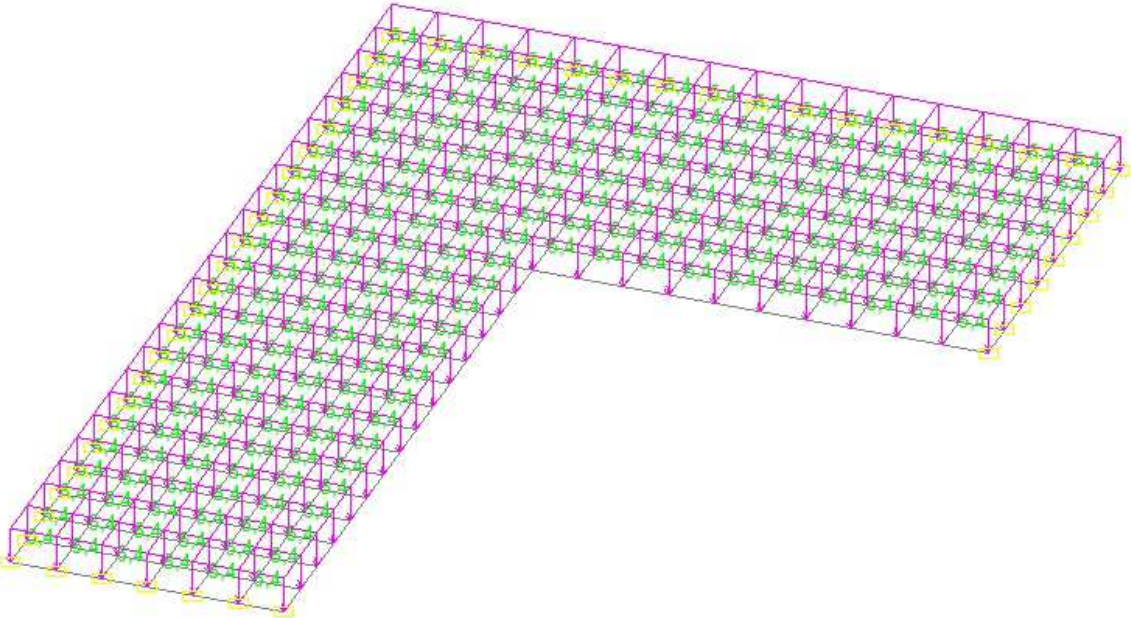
Схема загрузки плиты нагрузкой от собственного веса
